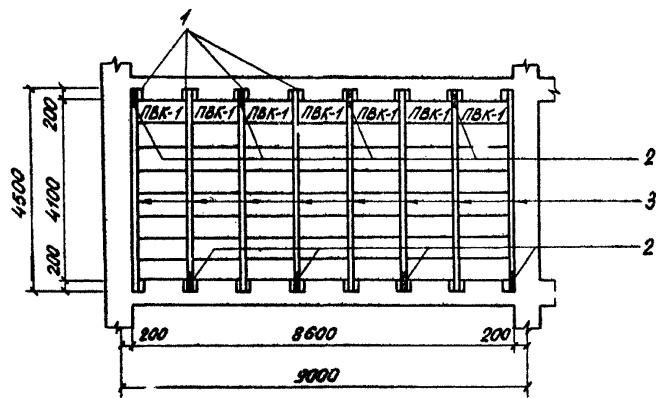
План участка перекрытия из балок ОБТ-430 с опиранием на протезы ПР-1 и мехбалочным заполнением из плит ПВК-1:
